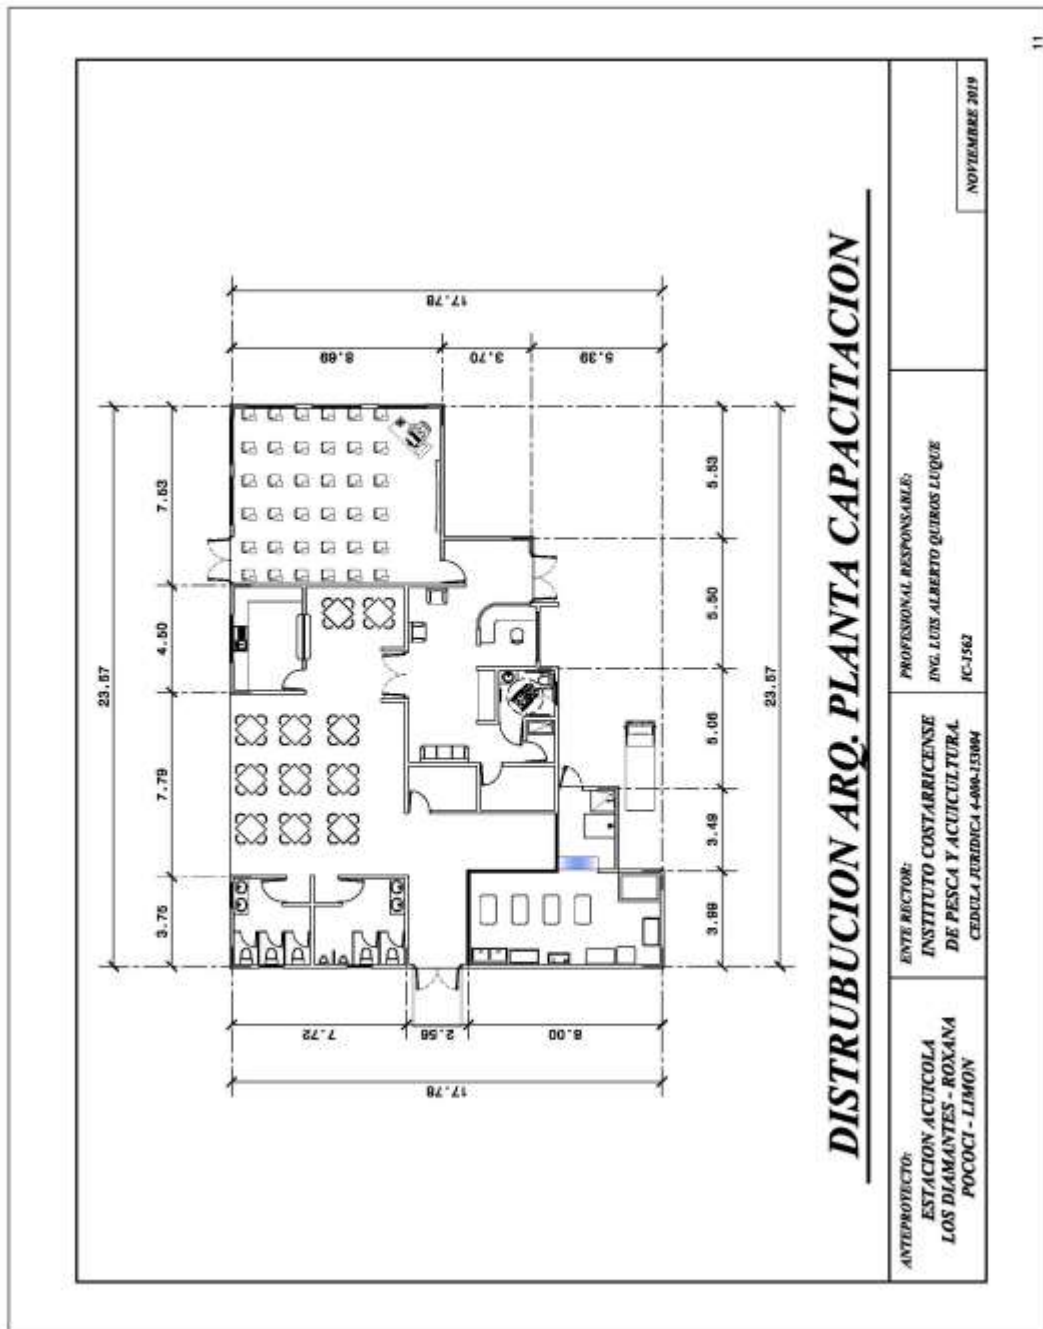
Distribución Arquitectónica de Planta de Capacitación
